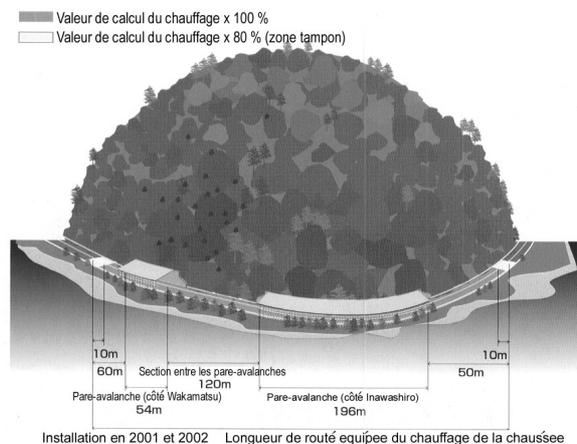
Vue en plan de la section équipée du chauffage de la chaussée
